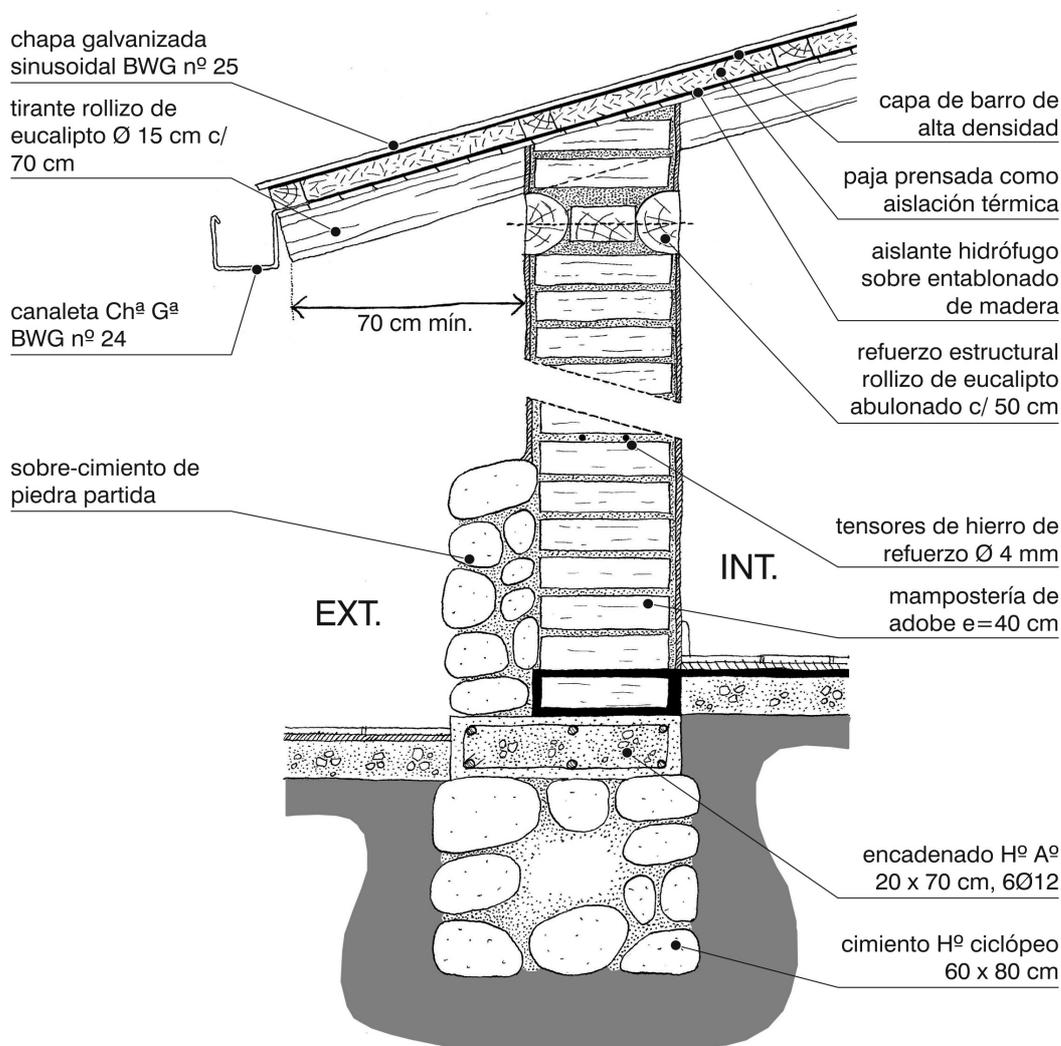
Corte del muro de adobe para la vivienda en Tucumán.
